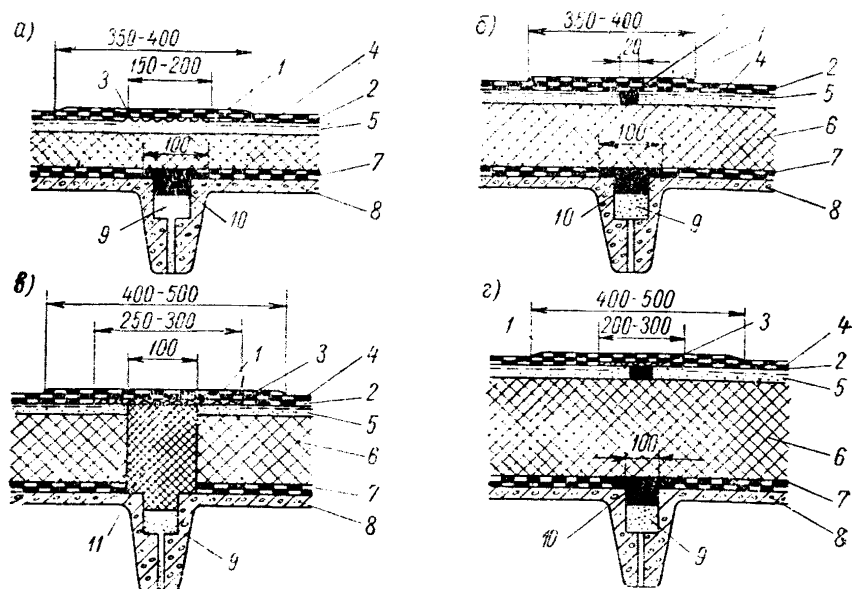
Конструкция безрулонных кровель на стыках железобетонных плит покрытия
